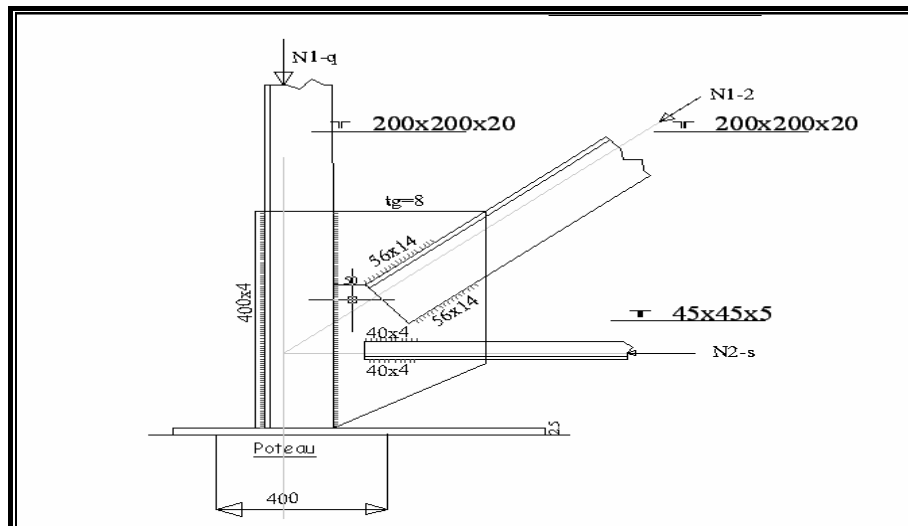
Schéma constructif de l'appui de la ferme sur le poteau.
